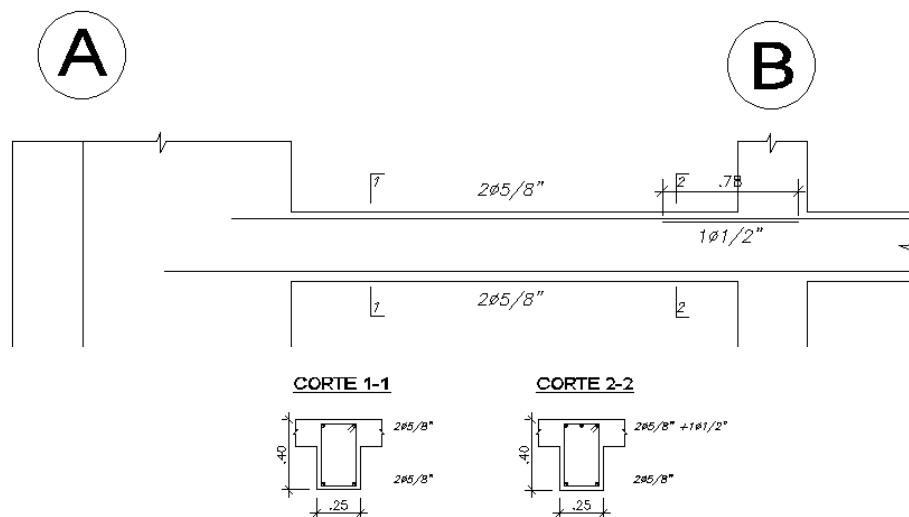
REFUERZO EN FLEXION PARA TRAMO 1 DE VIGA A (V-11) – DUAL TIPO I
